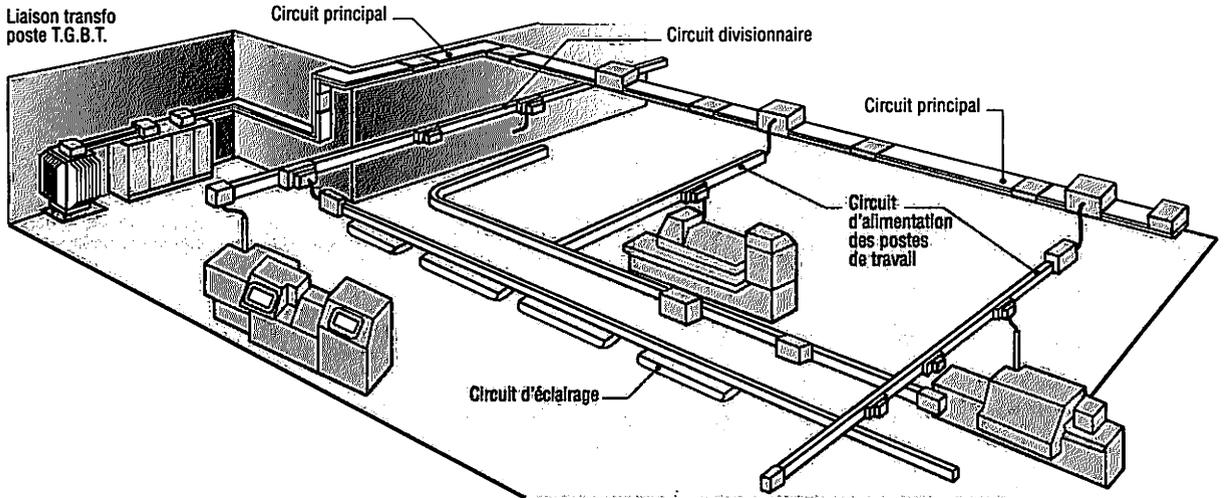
Exemple d'installation en canalisations préfabriquées.
